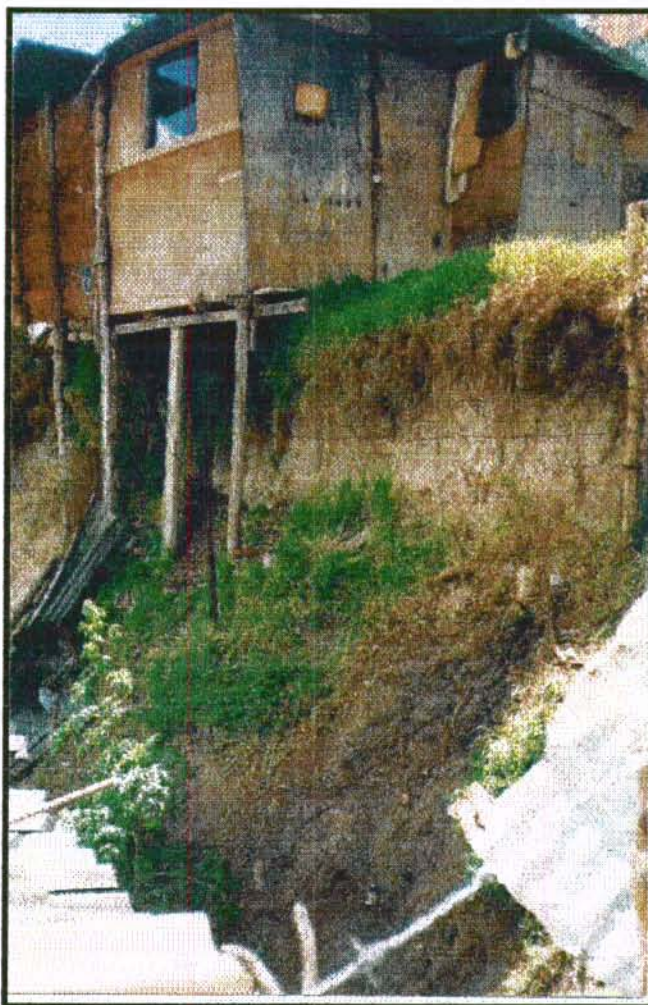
7. Sitio típico donde se recomienda construir escaleras y el sistema de conducción de aguas lluvias
